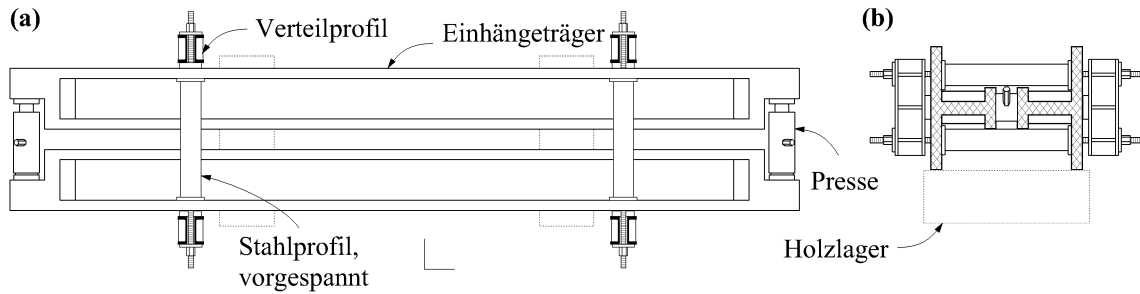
Belastungsvorrichtung für die Prüfung zweier Eihängeträger [V-89] – (a) Grundriss und (b) Querschnitt.
